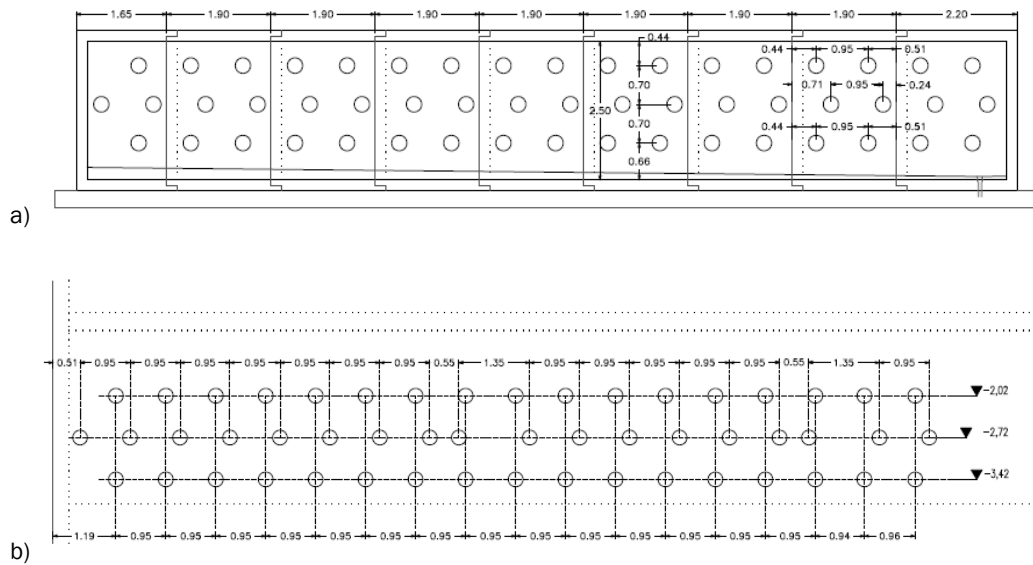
a) y b) Vista de la sección de los tubos en la galería de entrada de aire.
